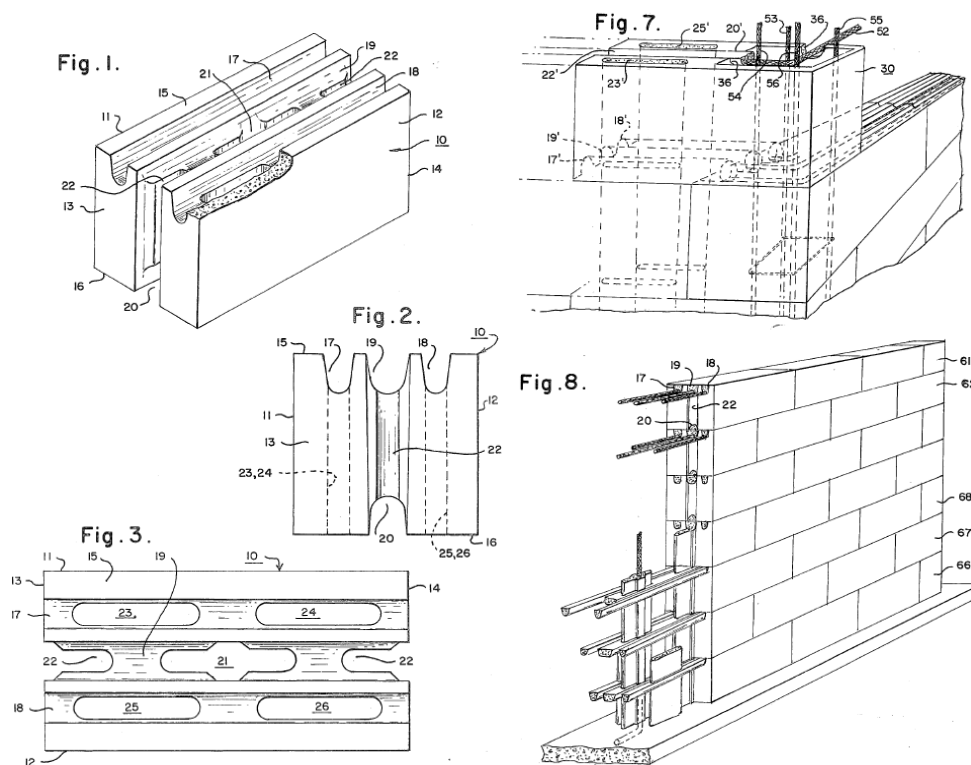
Patente de Clark Rassias. Muros estructurales.
